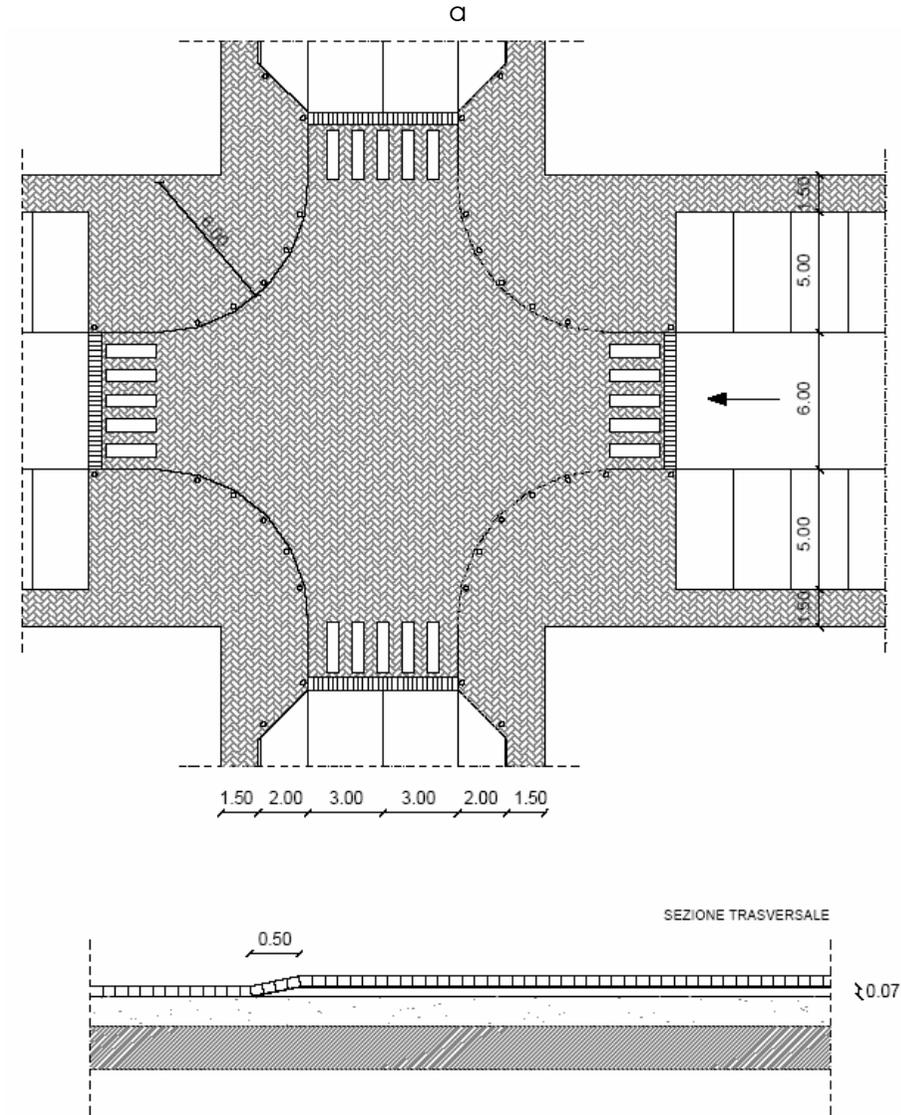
Moderazione Traffico – Incrocio pavimentato rialzato
